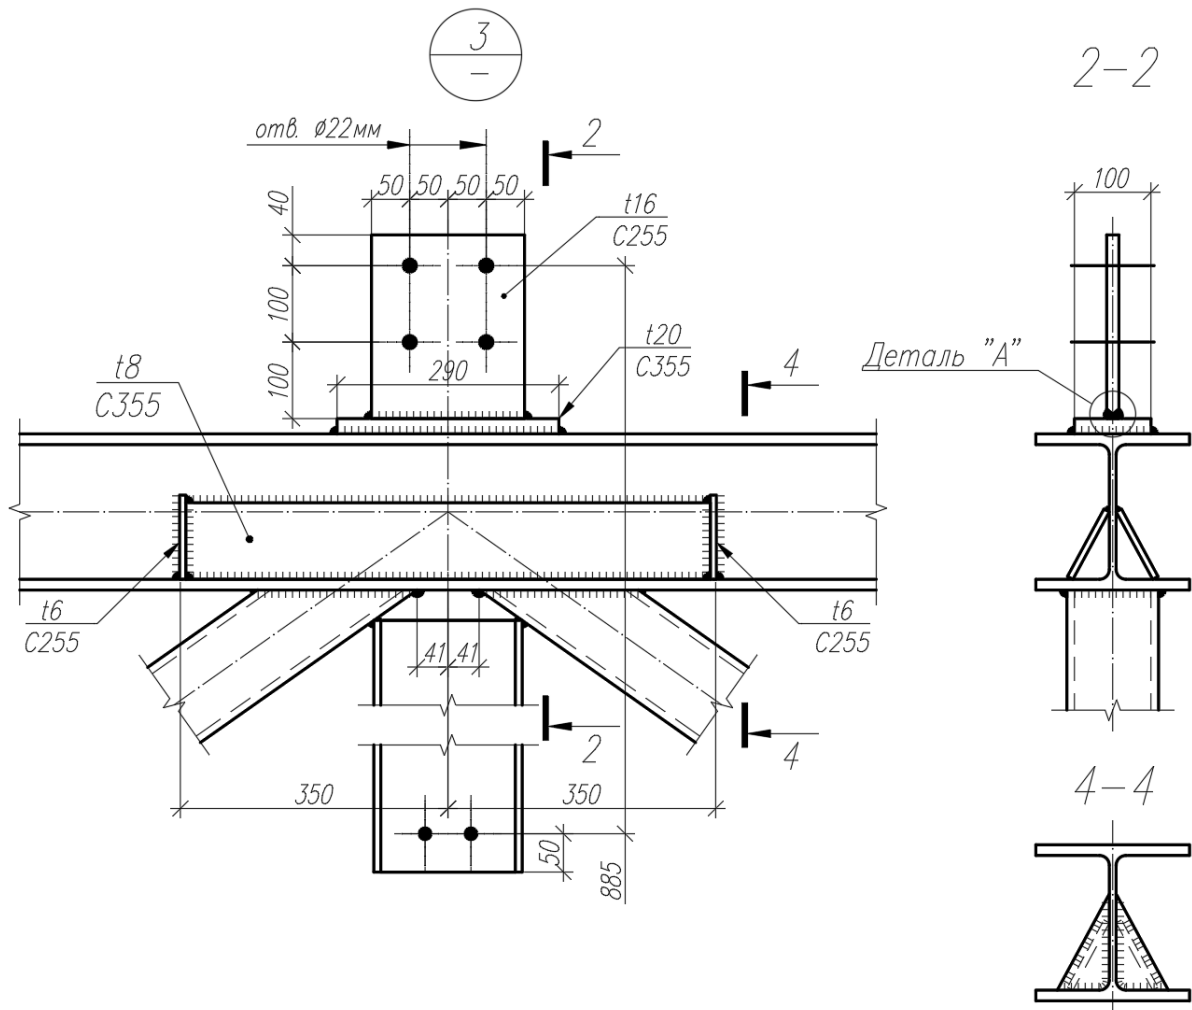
Узел 3 подстропильной фермы ФП-12-71,2.
